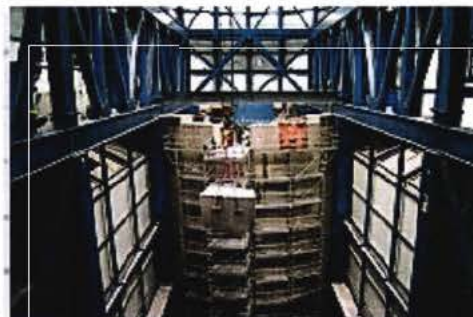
AVR-Jülich, BRD: Uitmaken verzaagde betonblokken uit biologisch schild.
